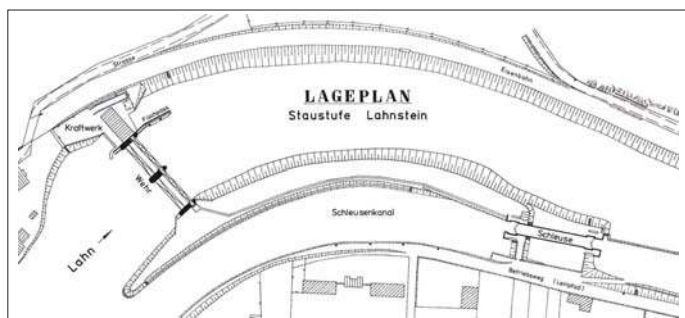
Lageplan Staustufe Lahnstein (Quelle: WSA Koblenz)
